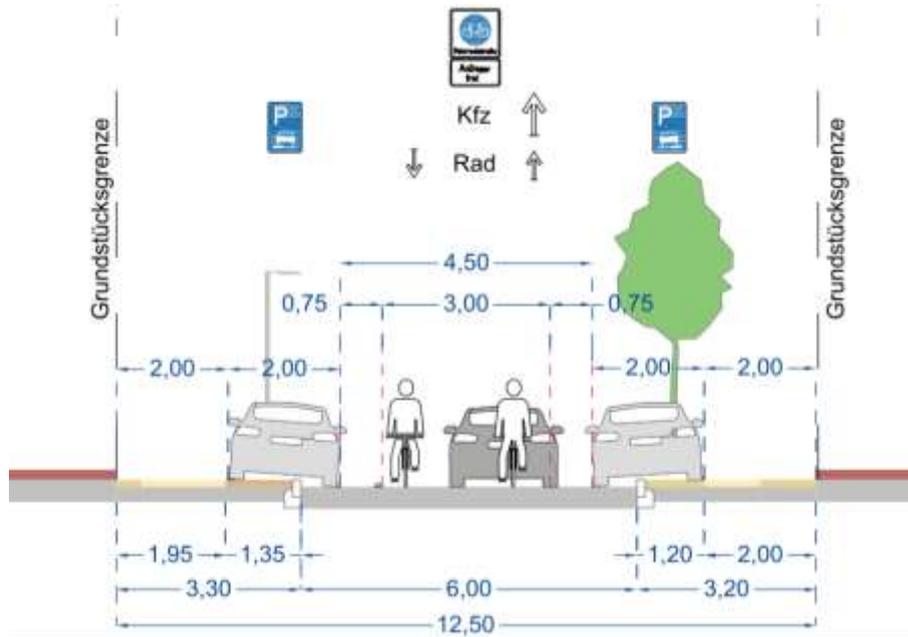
Straßenquerschnitt Cäsarstraße - Variante 1
